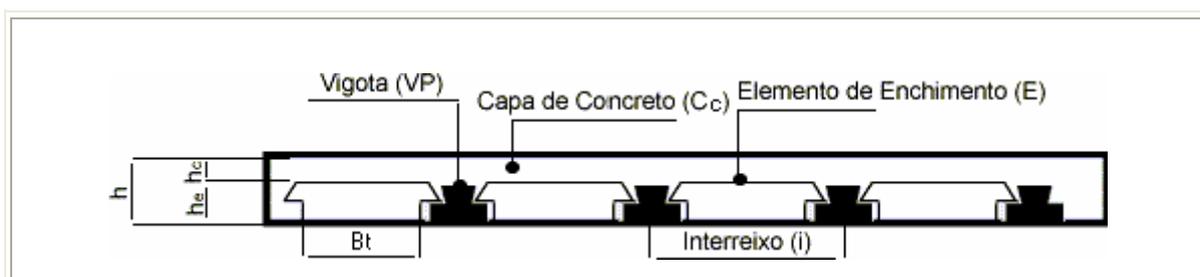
Laje com vigotas de concreto protendido (VP). (Adaptada)
